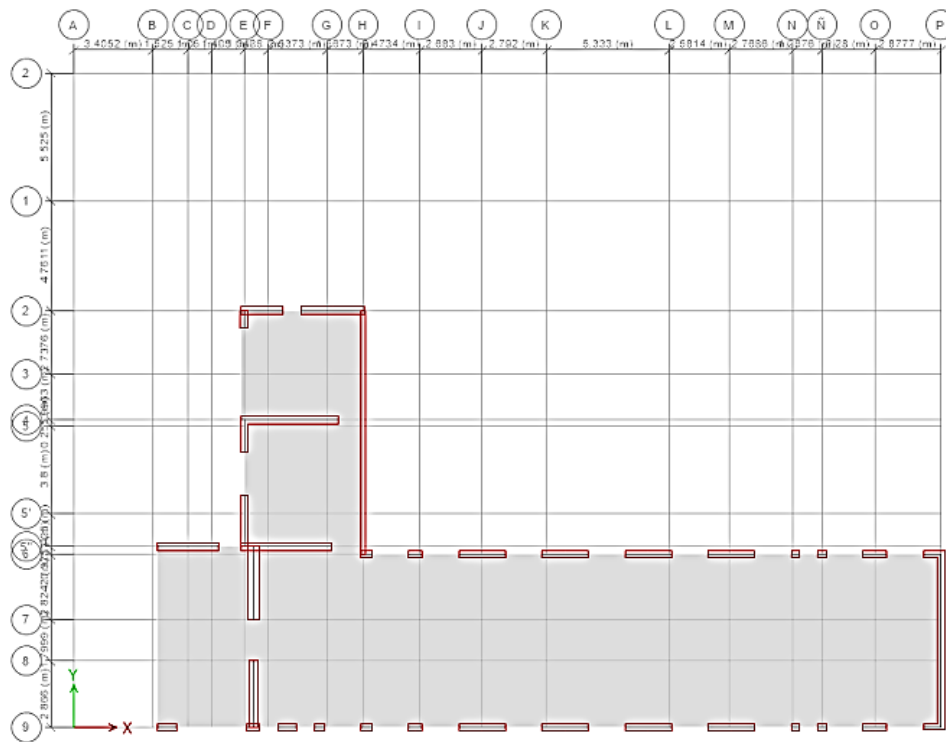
Configuración y disposición de los elementos estructurales en planta. Fuente: Autor
